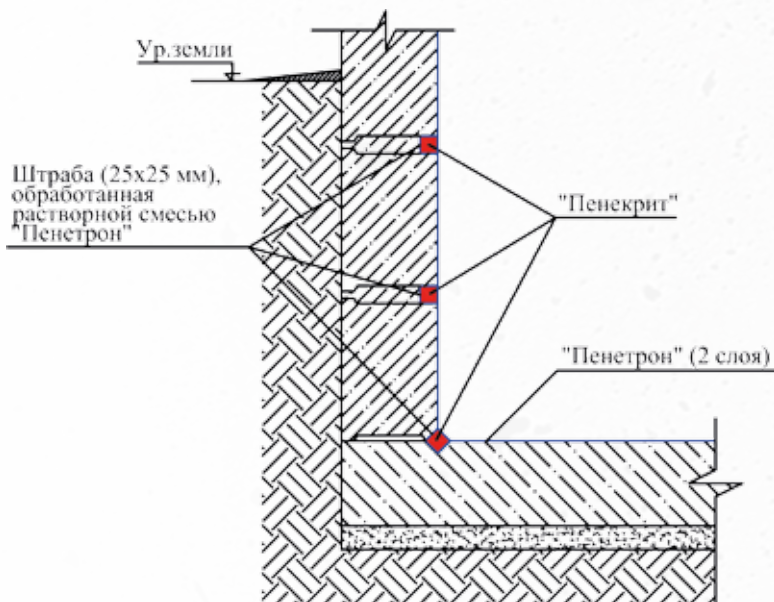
Гидроизоляция фундамента из бетонных блоков
